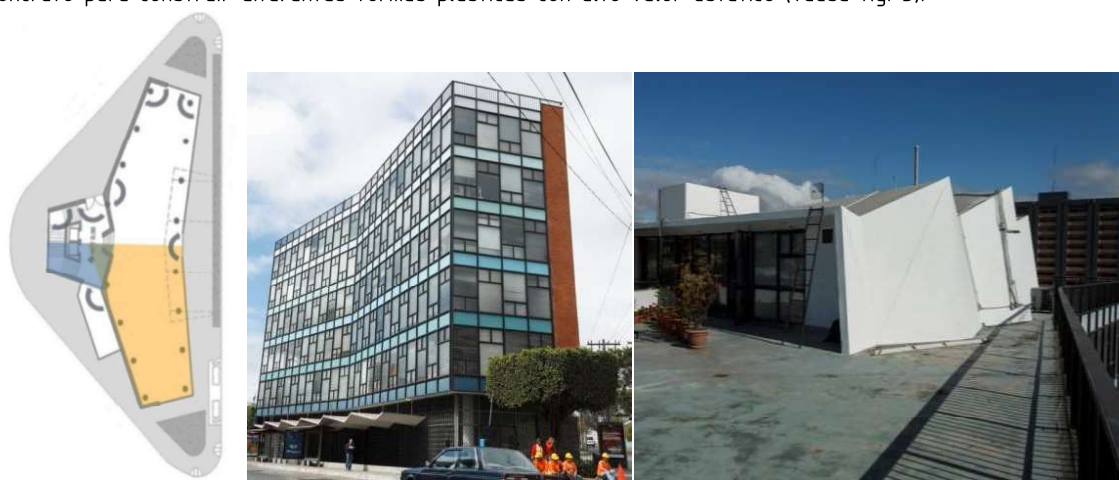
Geometría de la planta arquitectónica, muro cortina en fachada oriente y detalle de remate de *penthouse* en Edificio Italia.
